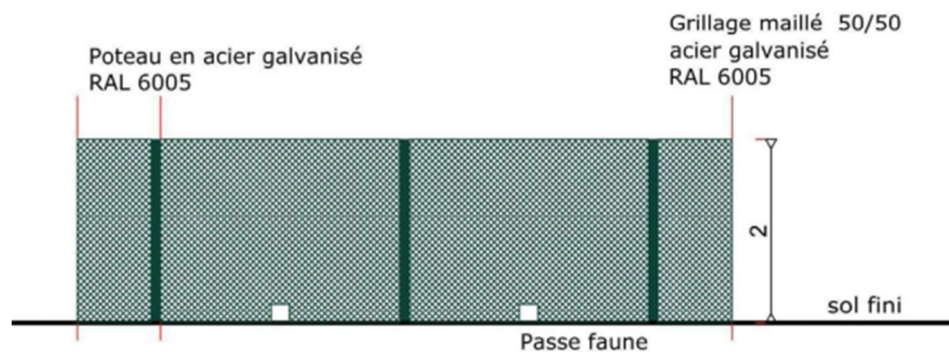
Exemple de plan de clôture (source : TSE)
